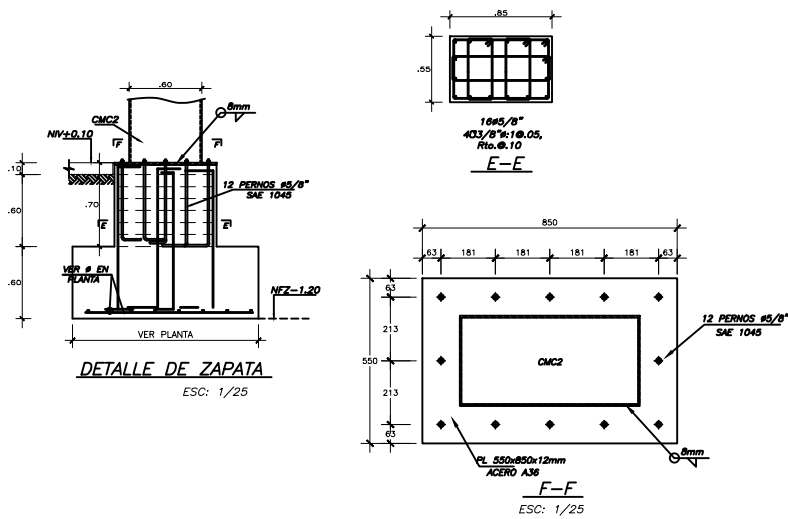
Planos estructurales - cimentación (ampliación)
